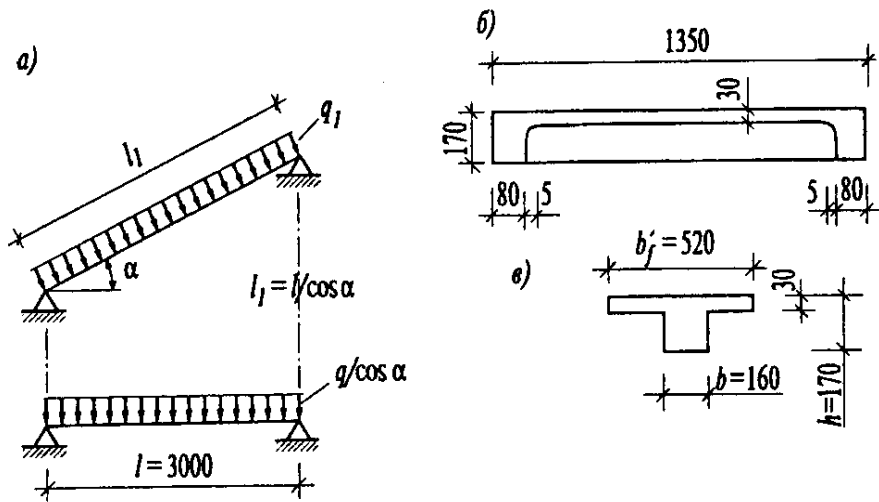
Расчетная схема, реальное и приведенное поперечные сечения.
